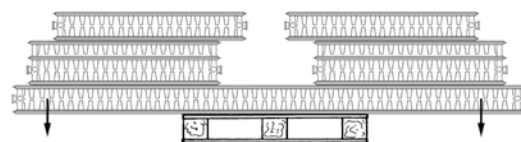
Falsche Lagerung führt zu Beschädigungen
